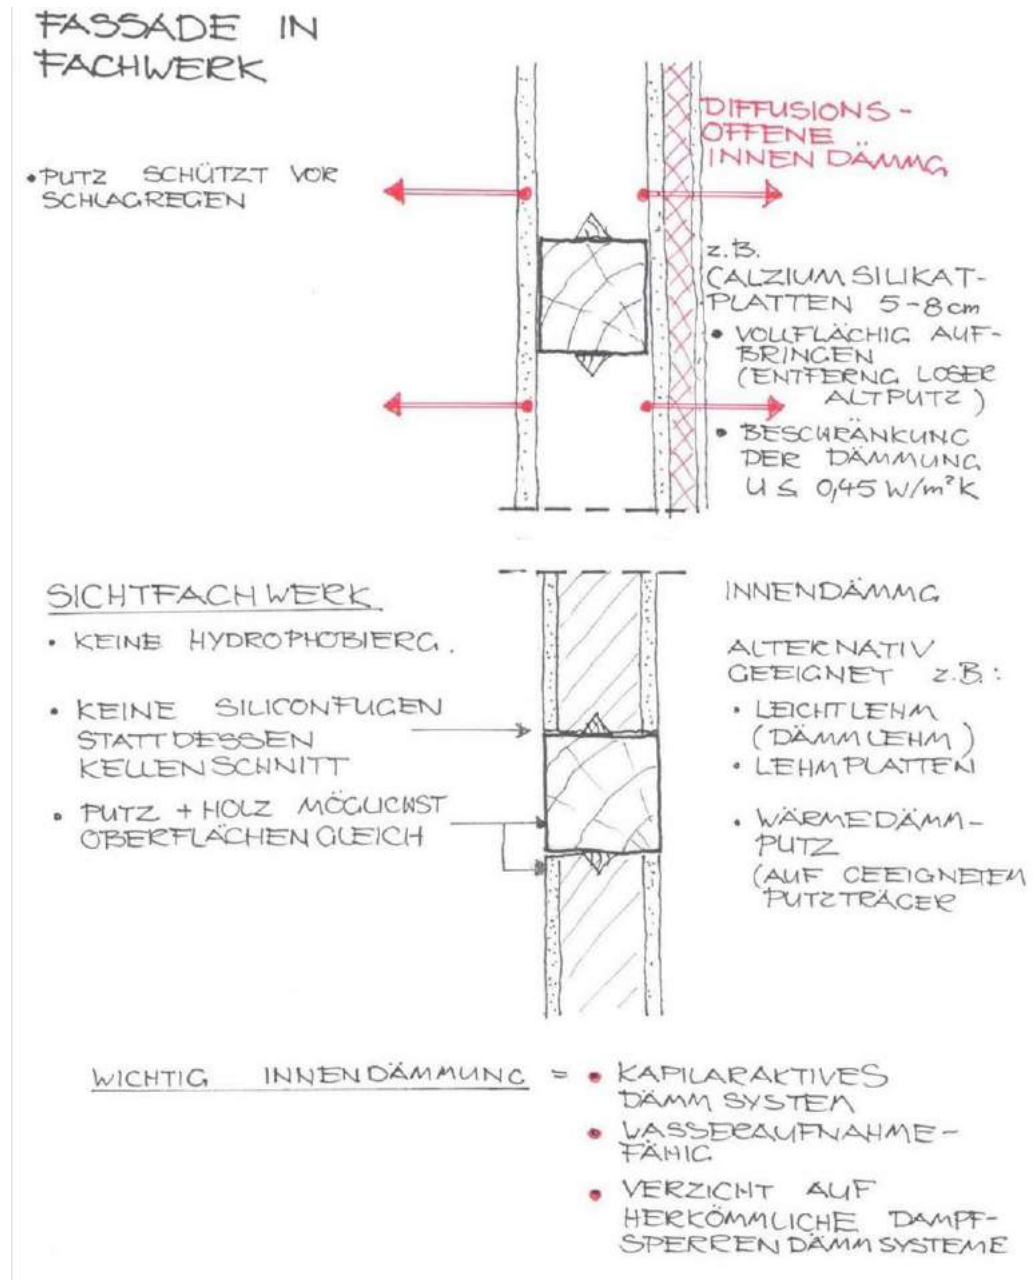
Gestaltungs- und Ausführungsdetail Fassade im Fachwerk
